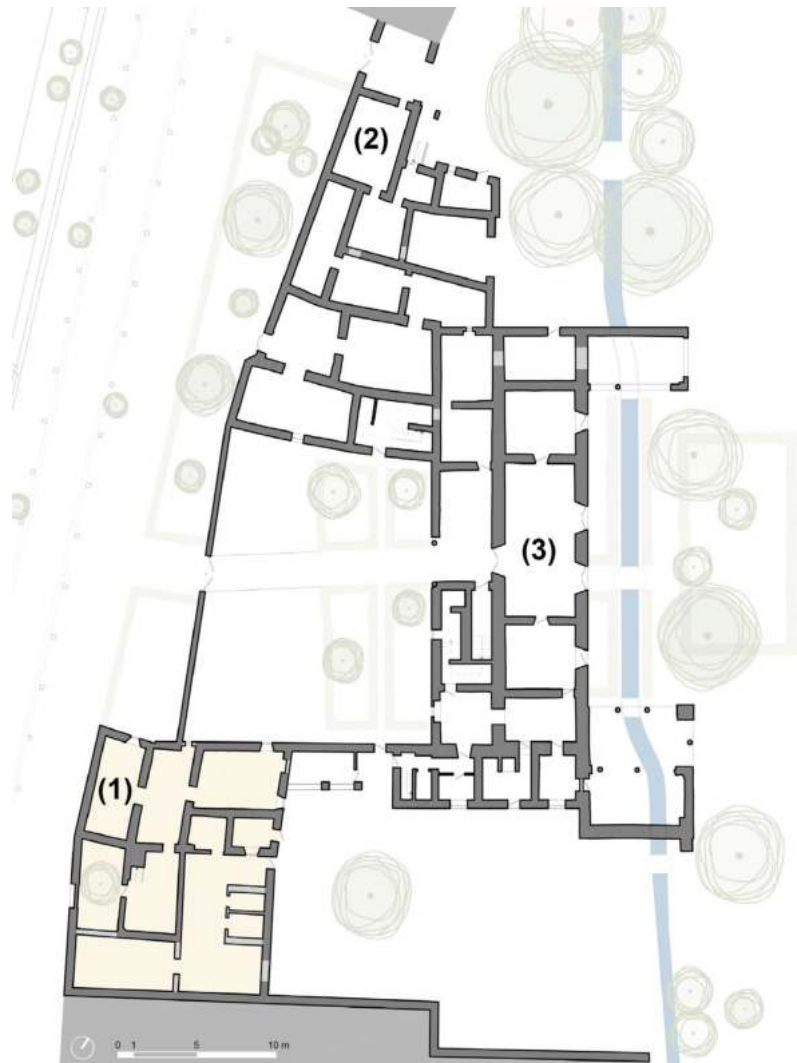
Plano actual de planta baja del complejo palaciego. Se observa la diferente alineación entre el sector correspondiente a la planta de la casa-torre (1) y las edificaciones situadas al norte del complejo (2), frente al edificio trazado en paralelo al curso del Caz Mayor (3).
